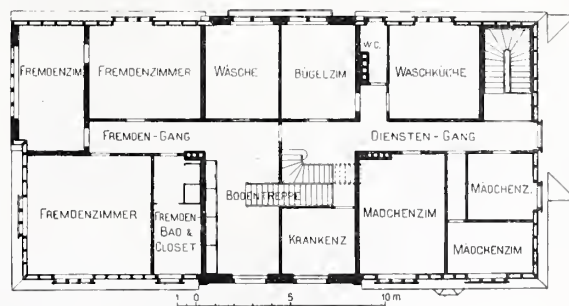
Grundriss vom Dachgeschoss. — Masstab 1 : 400.
